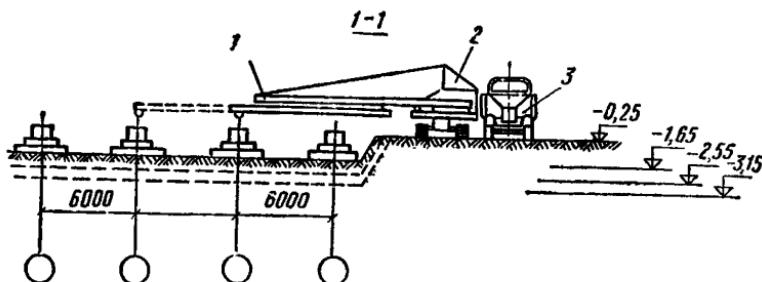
Схема бетонирования фундаментов самоходным бетоноукладчиком
